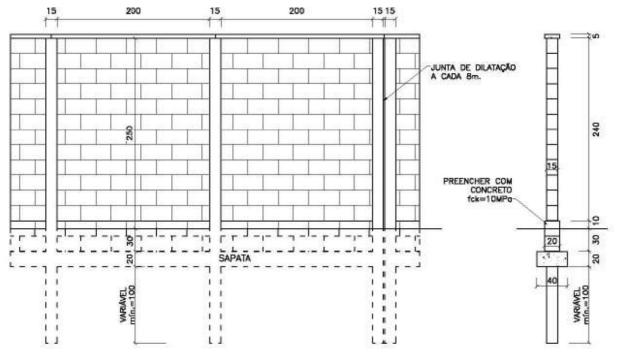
Demonstração esquemática do muro em bloco de concreto aparente.
